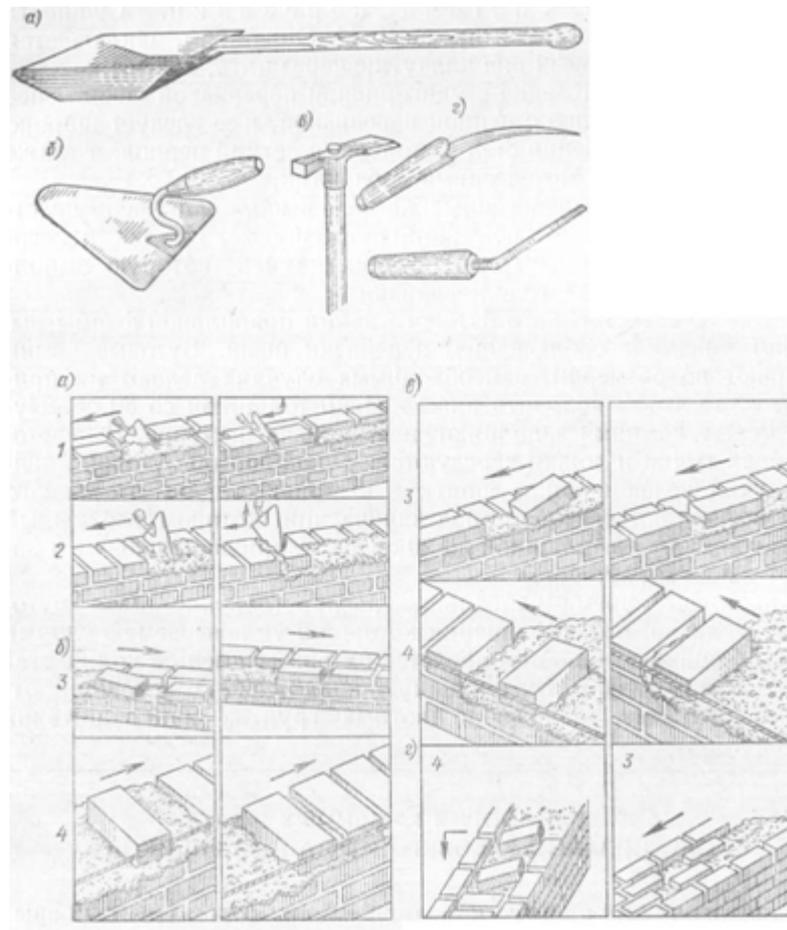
Рабочий инструмент каменщика а—лопата растворная; б — кельма; в — молоток кирпичка; г — расшивки
